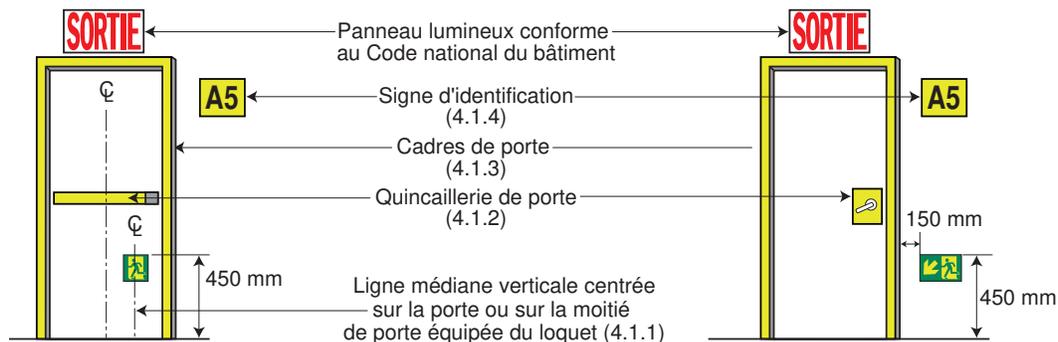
Panneau d'issue, fixé sur la porte ou au mur
